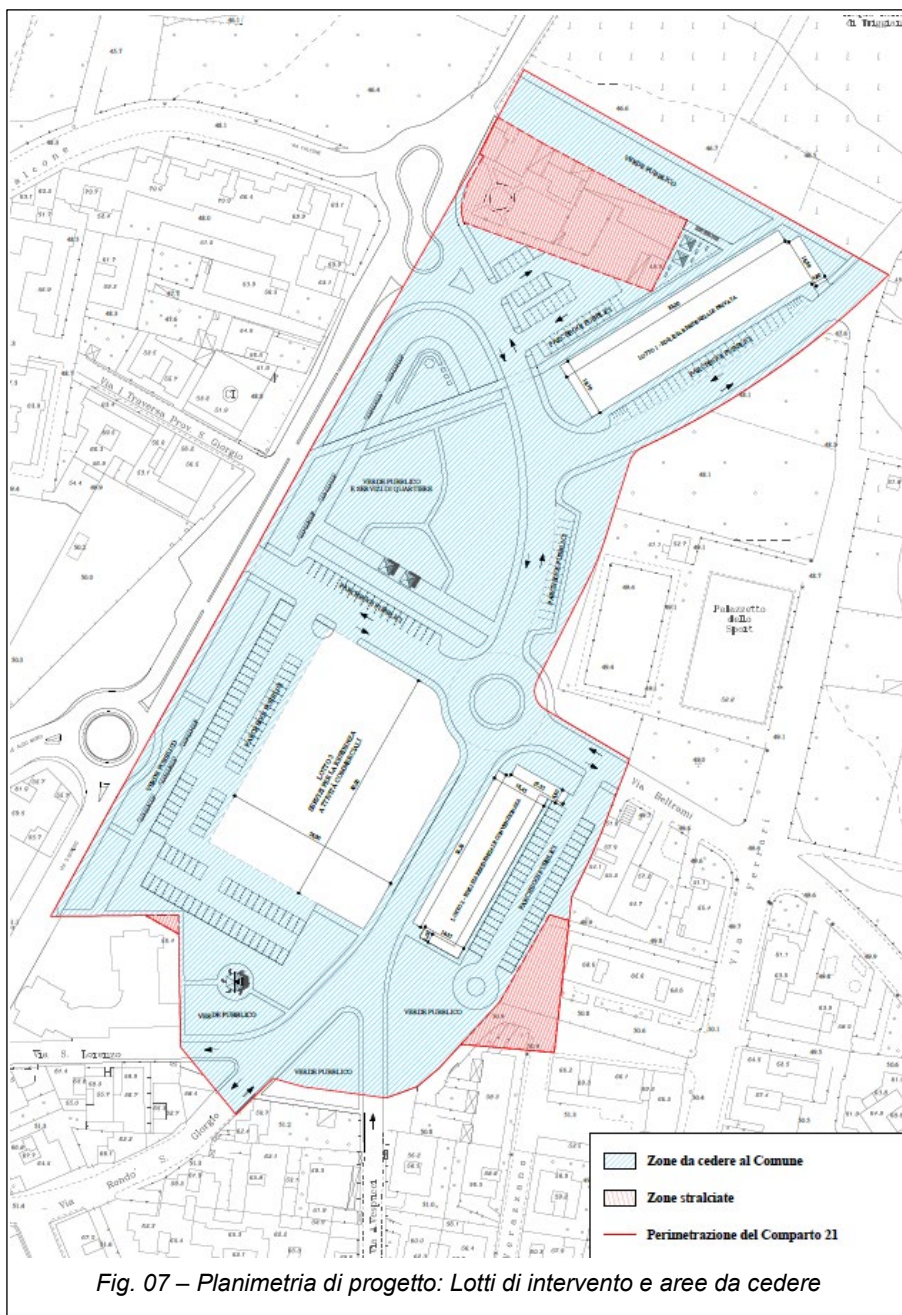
Planimetria di progetto: Lotti di intervento e aree da cedere
